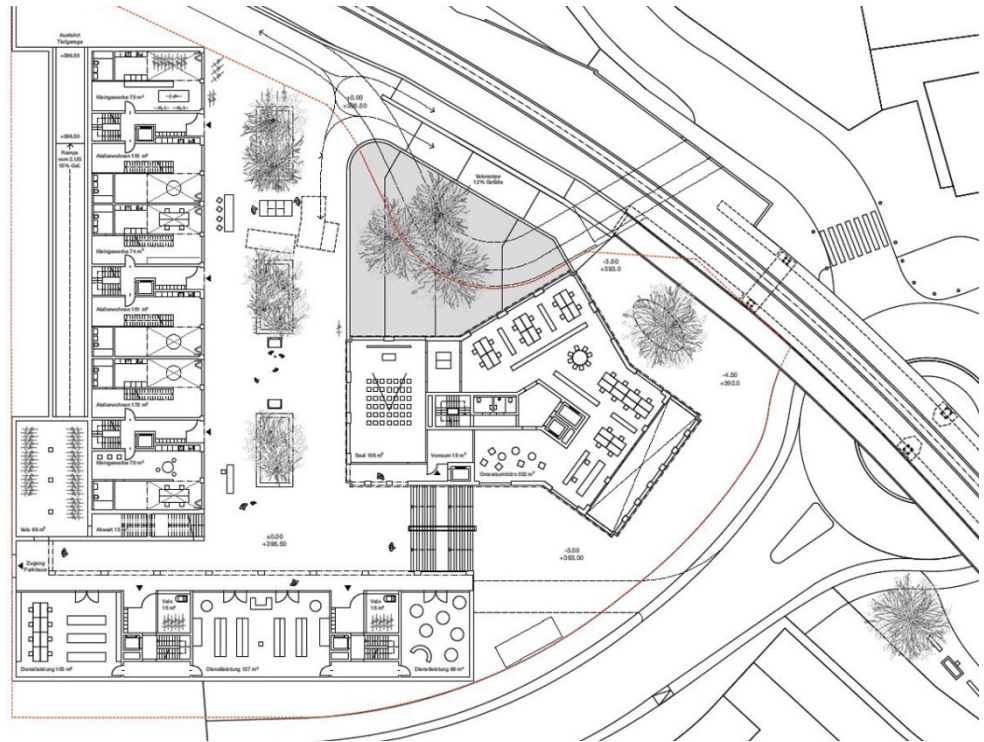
Grundriss EG (Hofgeschoss)
